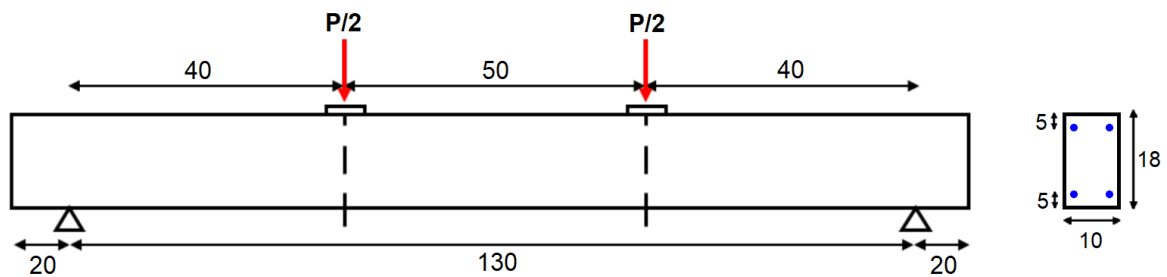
Configurações das vigas de Lim e Oh (1999) (medidas em cm).
